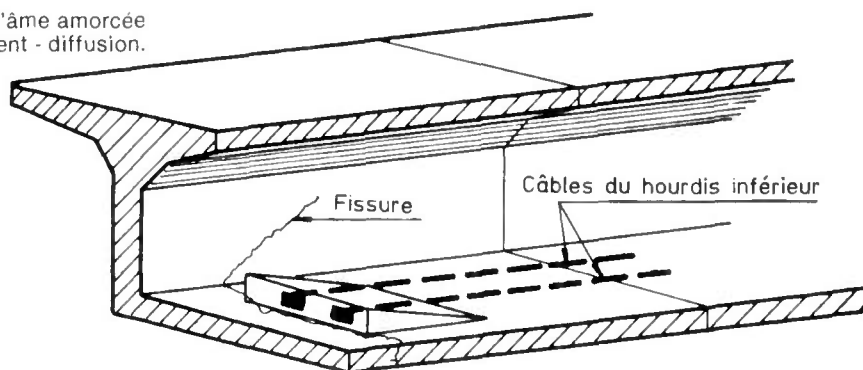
Fissuration dans l'âme amorcée par une fissure d'entraînement - diffusion.
